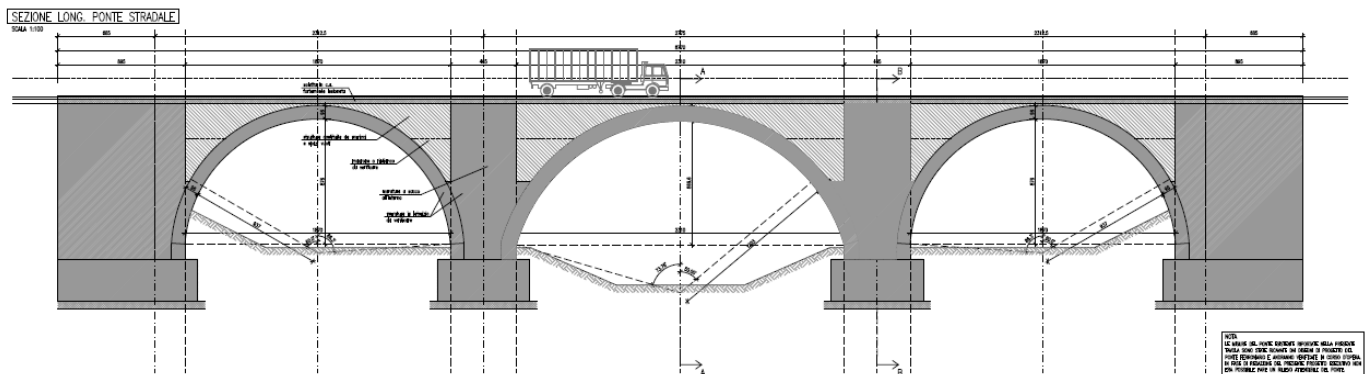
Sezione longitudinale del Ponte di Sorbolo.
